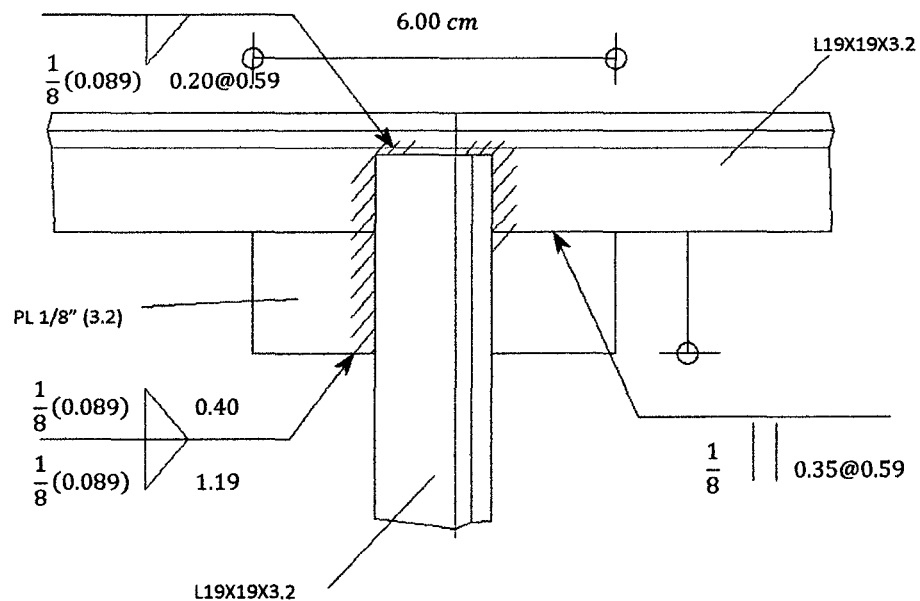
79: Detalle de Conexión en Viga VP-02.
